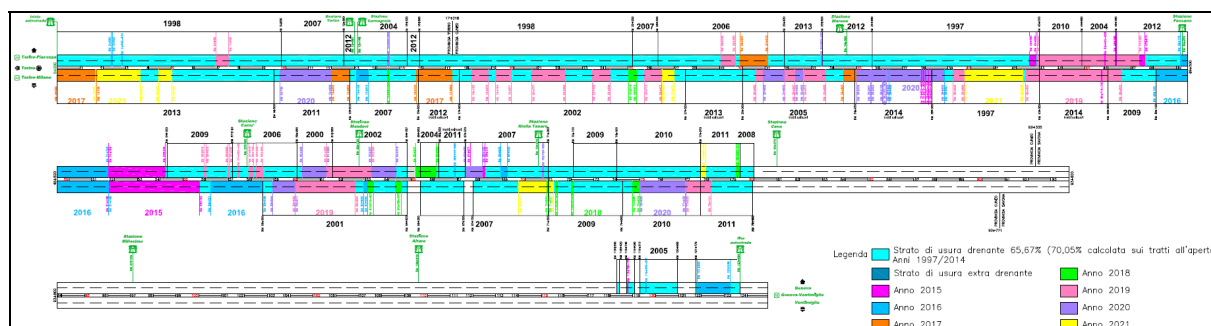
Planimetria schematica usura drenante con anni di stesa
